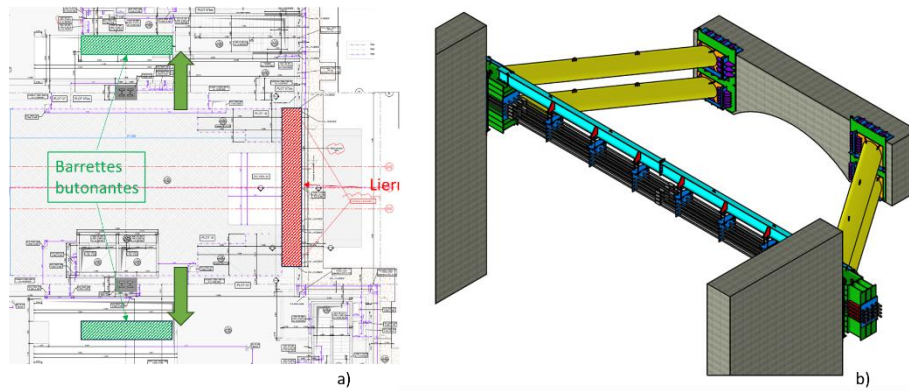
Vue en plan a) et 3D b) des barrettes butonantes et de la lierne BA
